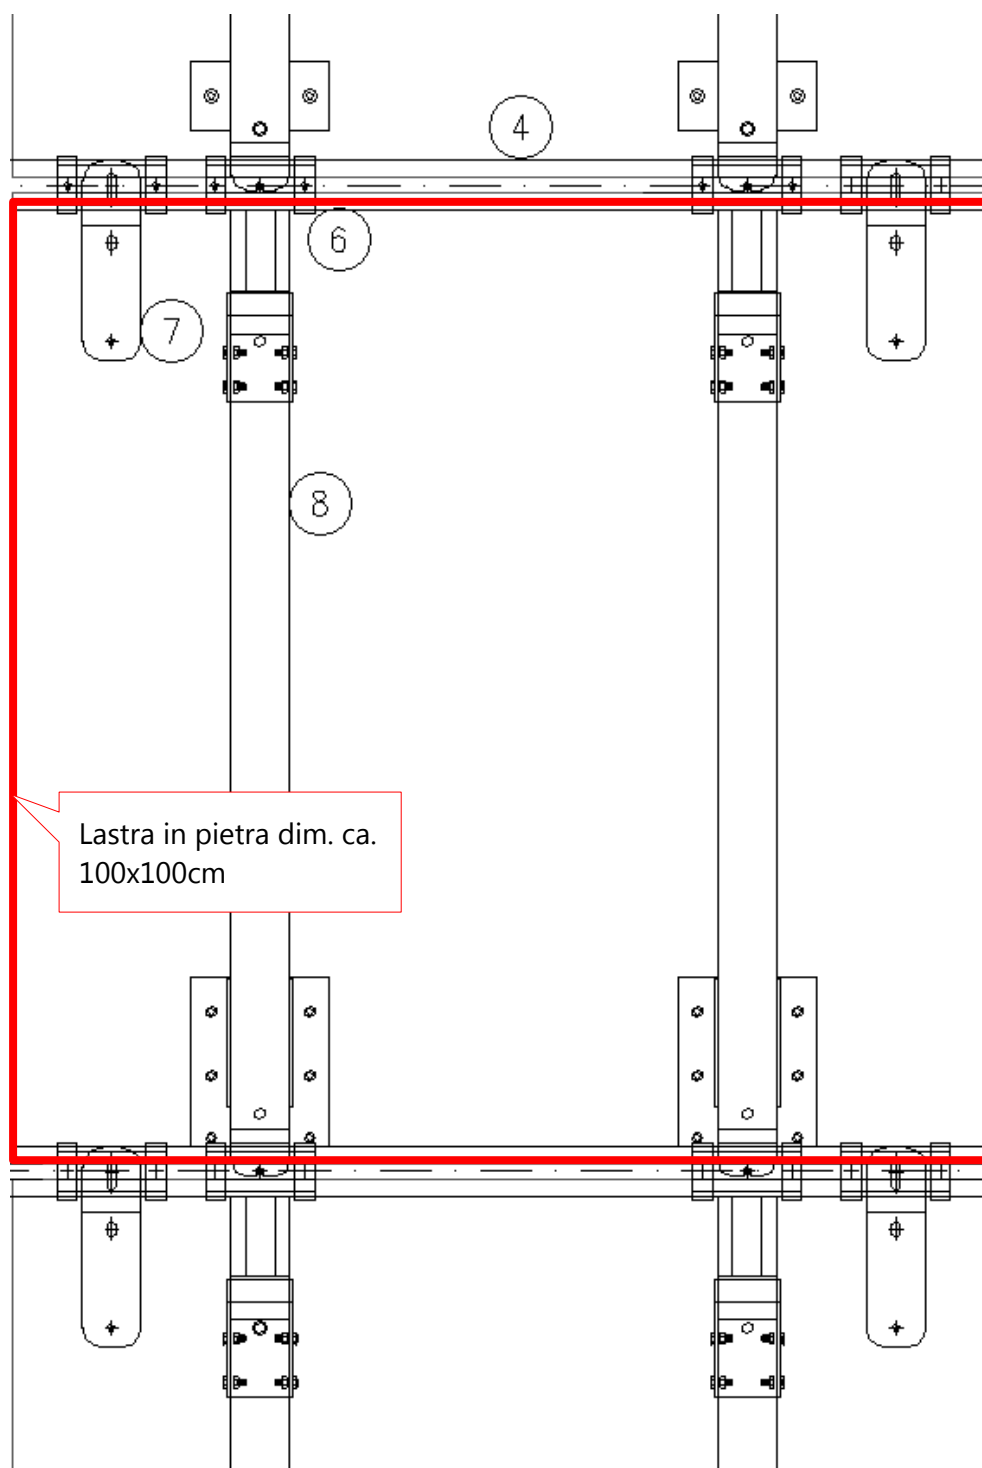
Modulo tipo sottostruttura. Vista in prospettiva
